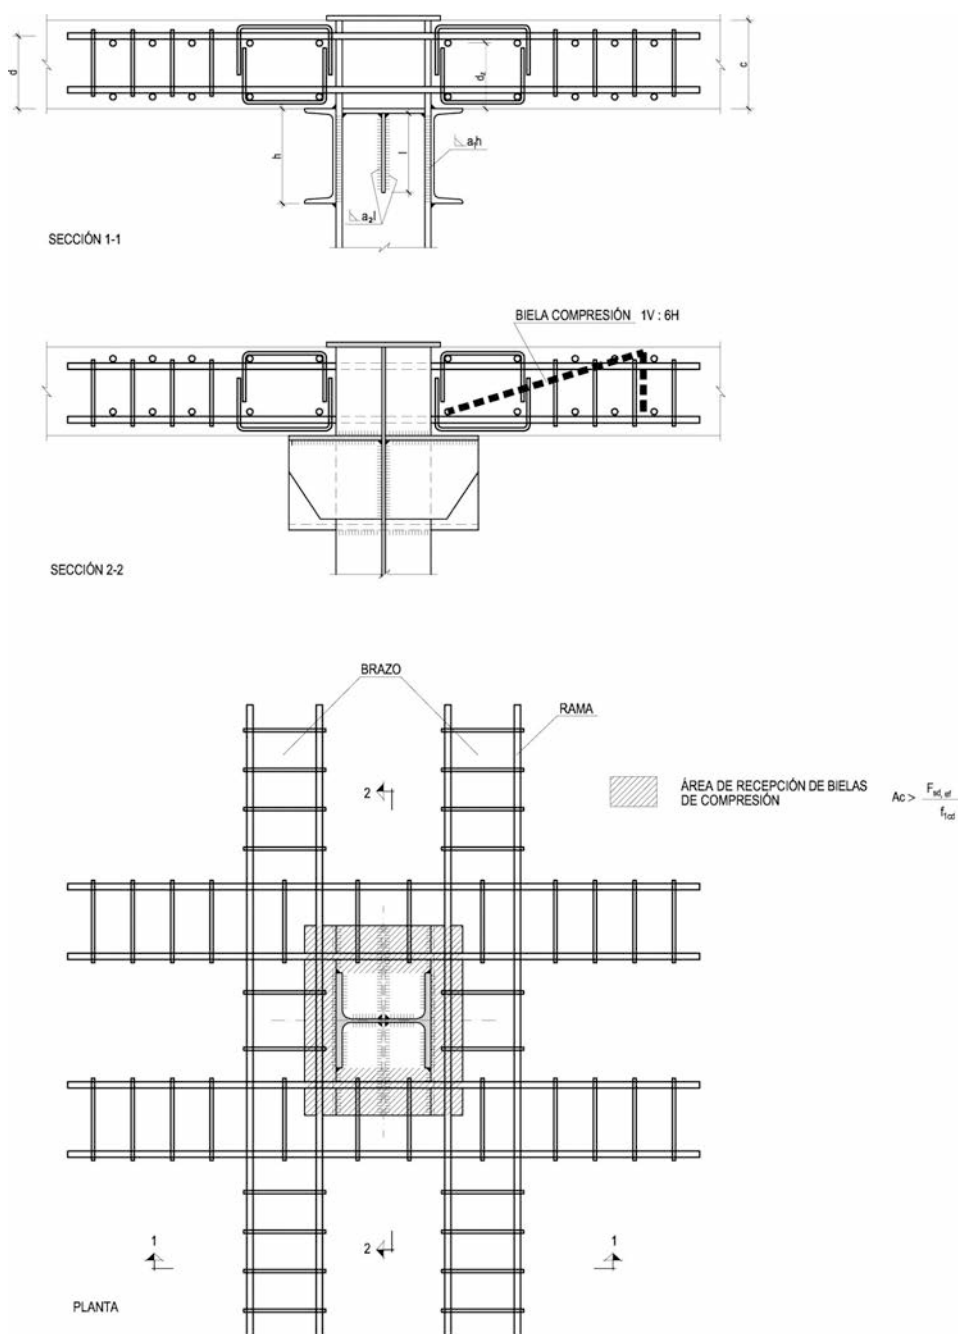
Detalle de punzonamiento entre soportes metálicos y forjados de hormigón con bandejas metálicas
